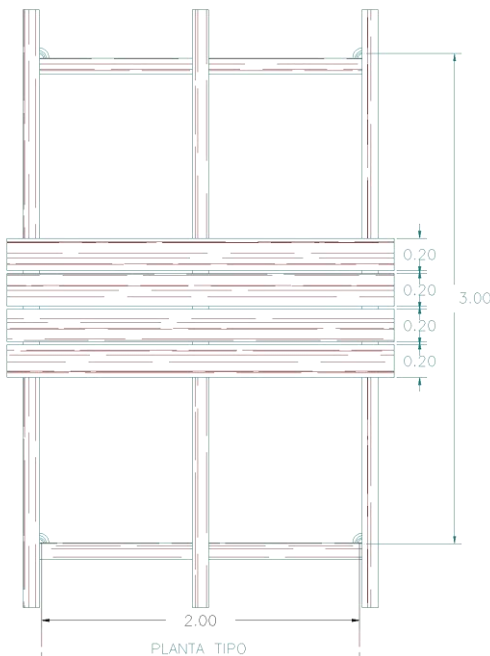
Detalles constructivos del arranque y Muelle de madera
